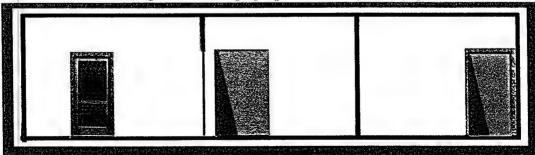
/١٢٤) مسقط أفقي يوضح قطاعاً بالشقة
